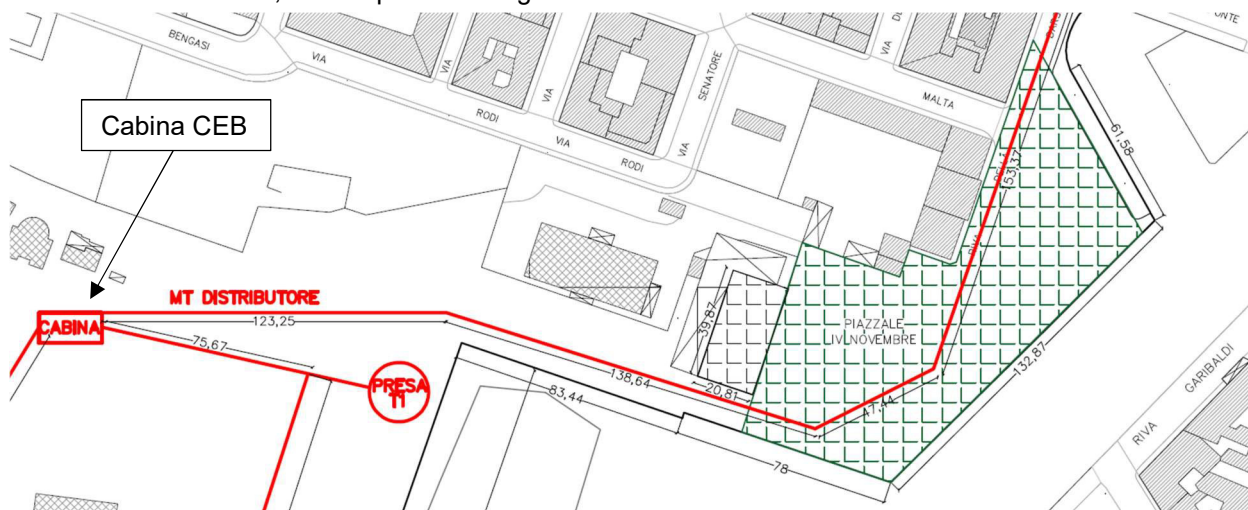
Stralcio della planimetria di progetto del PFTE (elaborato: SFTEPP05 – Rev. A)
